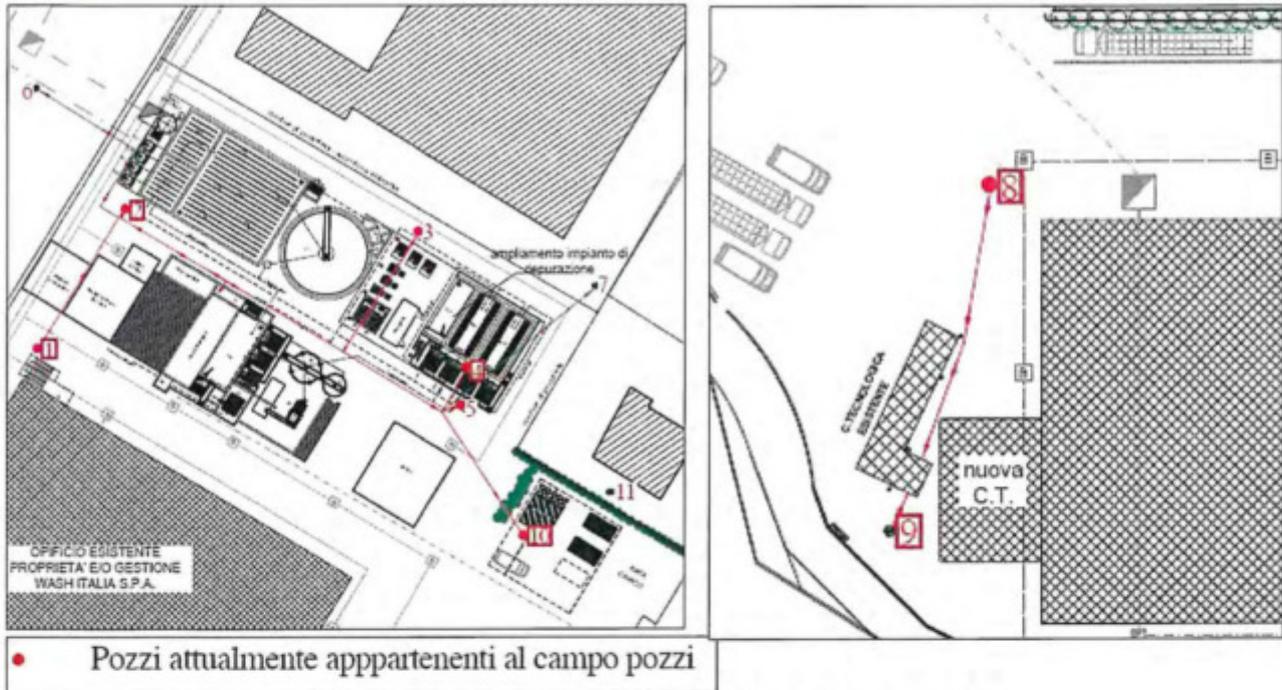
Planimetria ubicazione pozzi (da integrazioni allo SIA)
